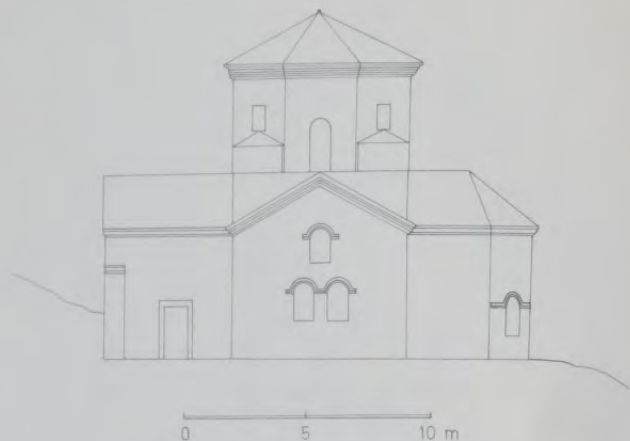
Kirche 2, rekonstruierte Ansicht von Süden. M 1:200
